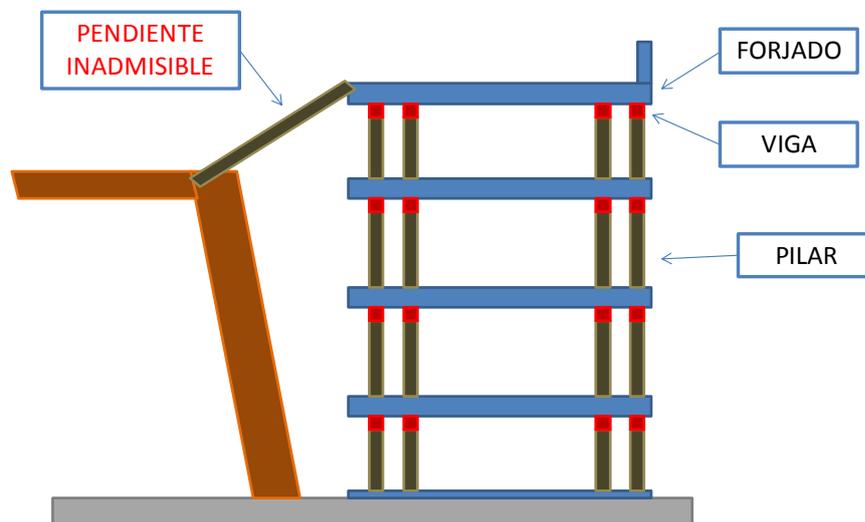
Croquis de la solución no seleccionada pilar + viga + forjado (Elaboración propia)
